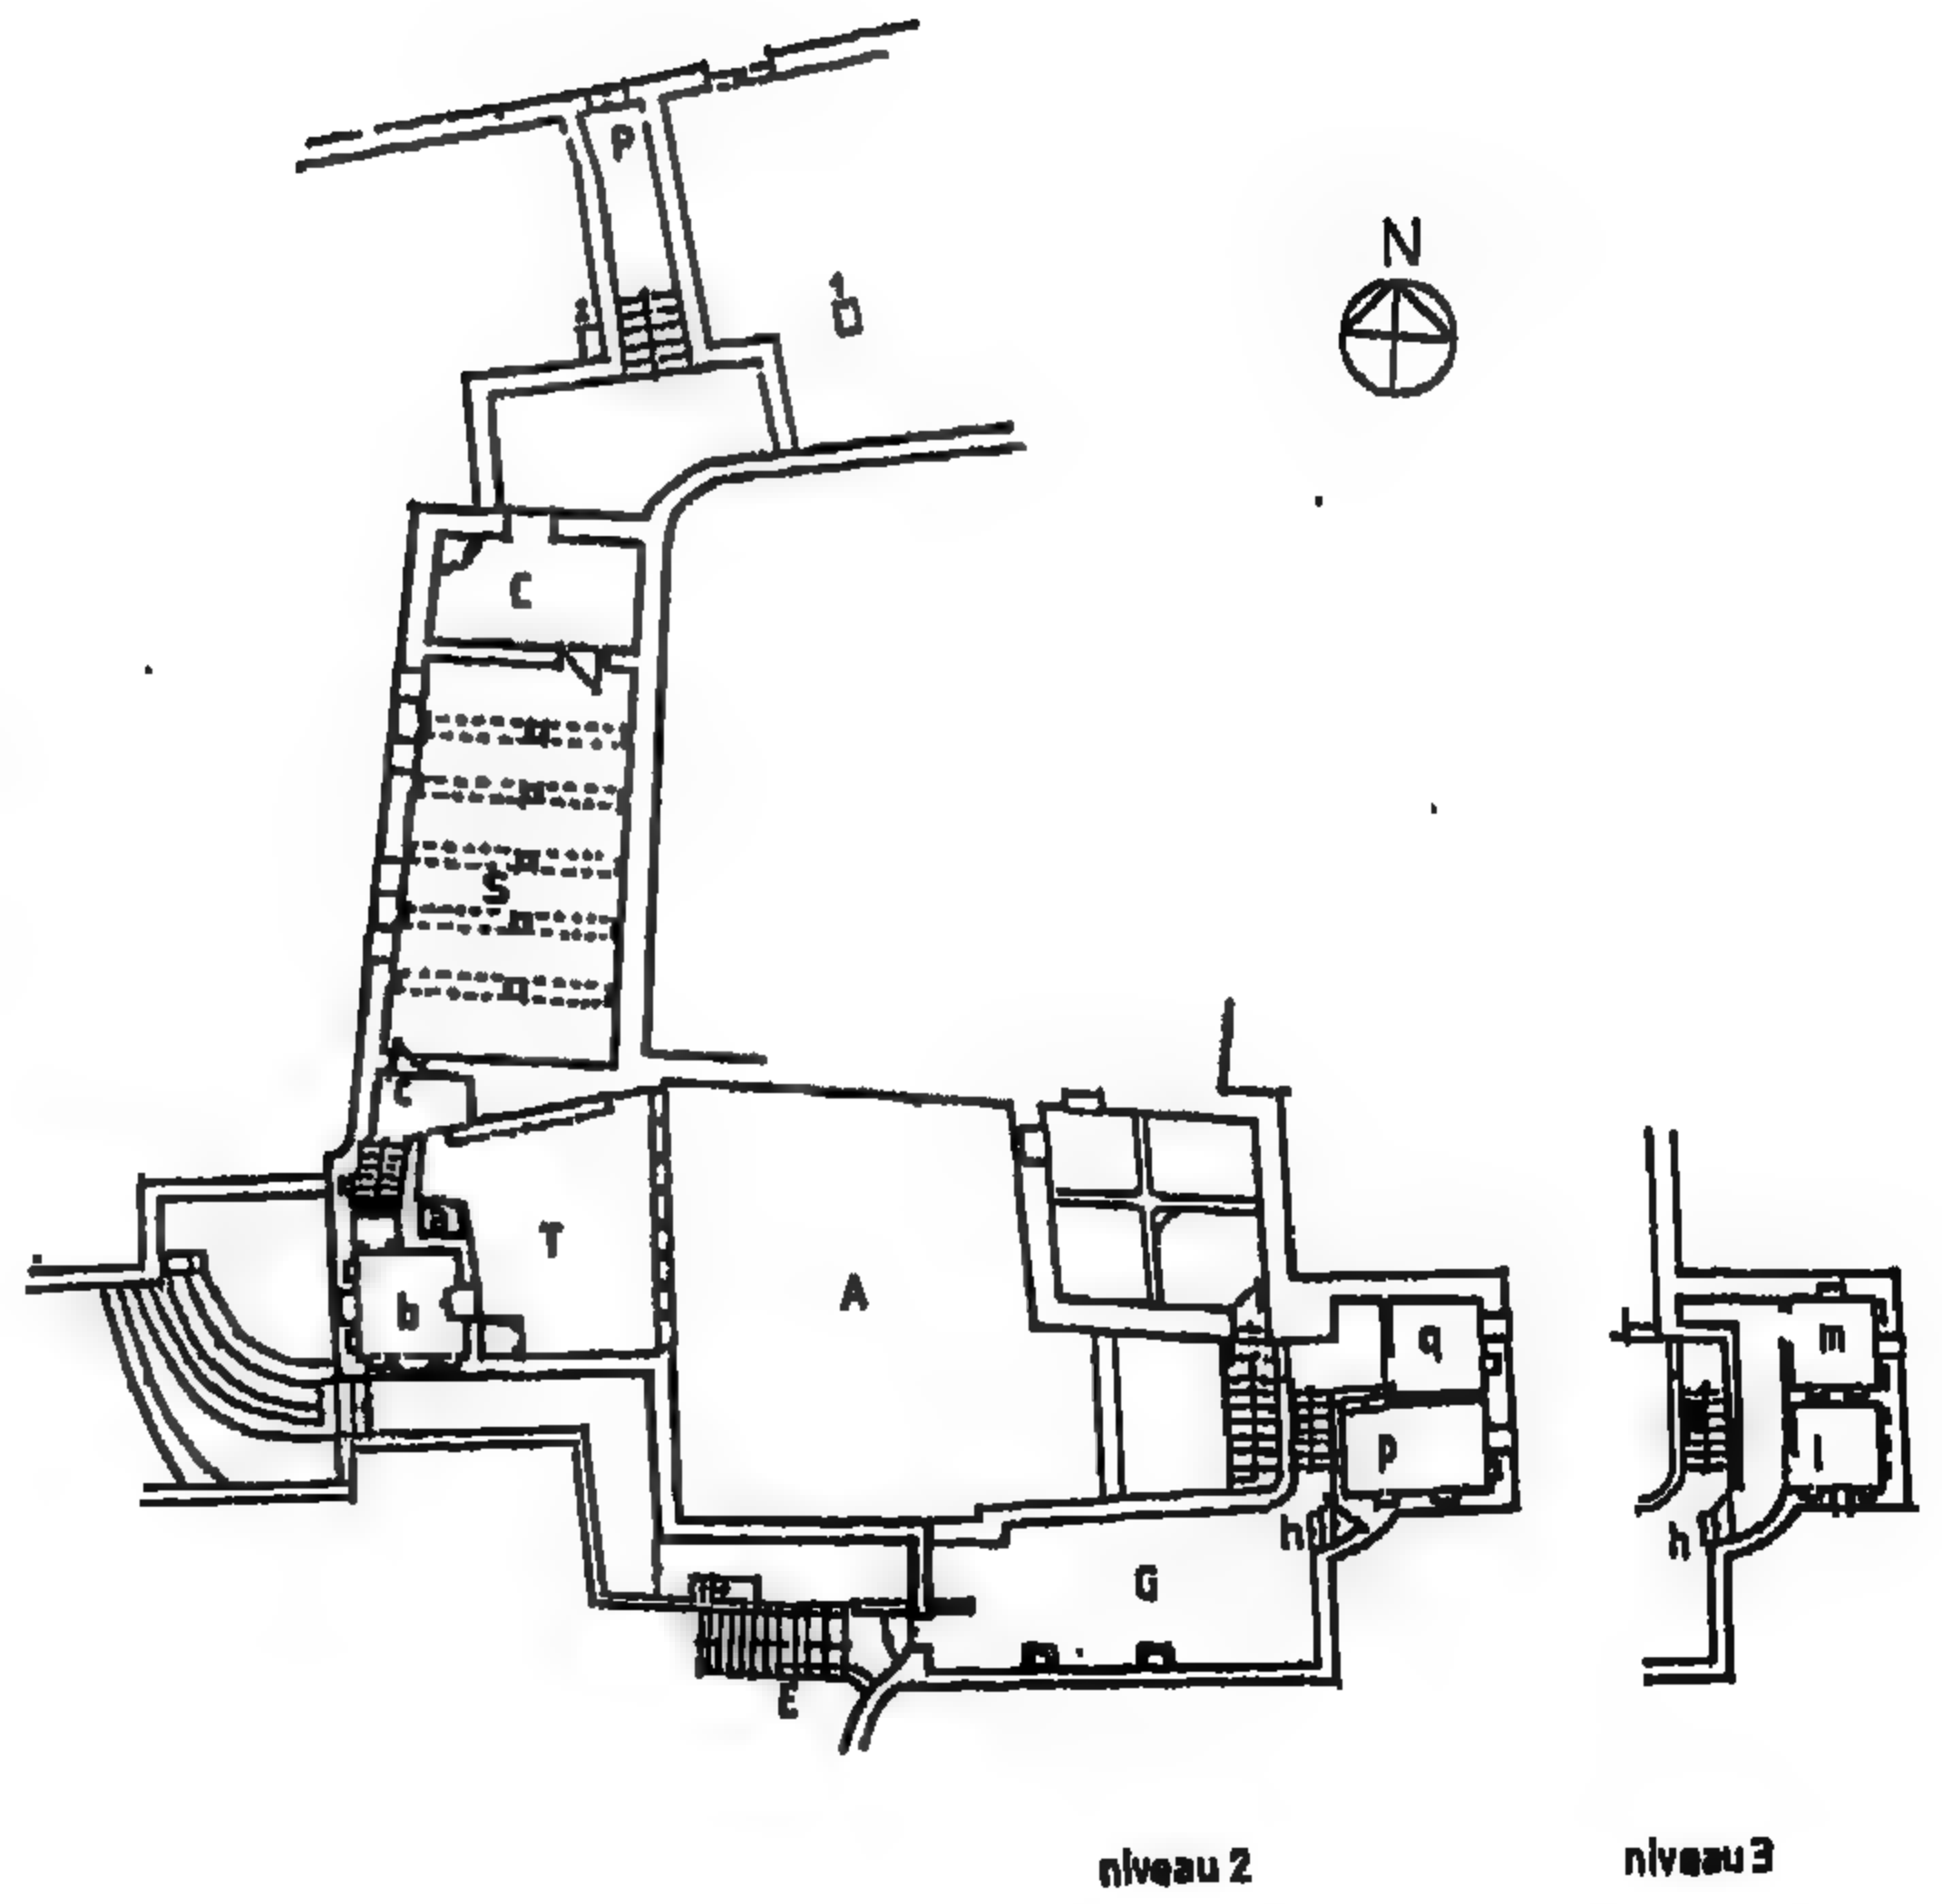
مسقط أفقي لمسجد القبة بمدينة ذي السفال (عمل الباحث)
